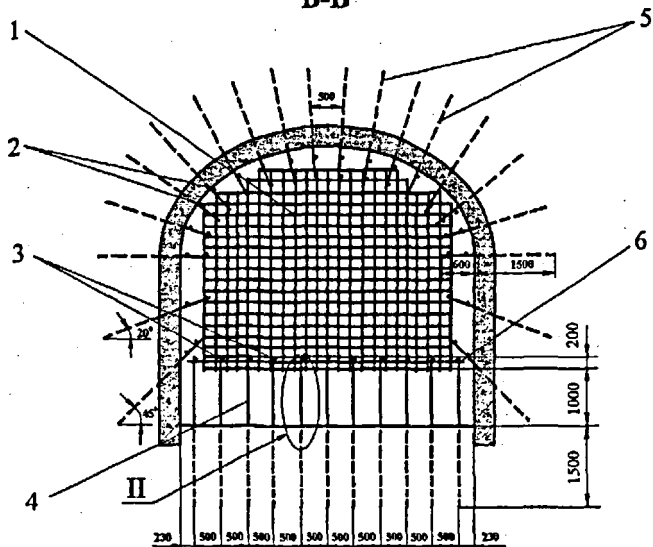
Схема расположения арматуры, железобетонных анкеров и кондукторов:
